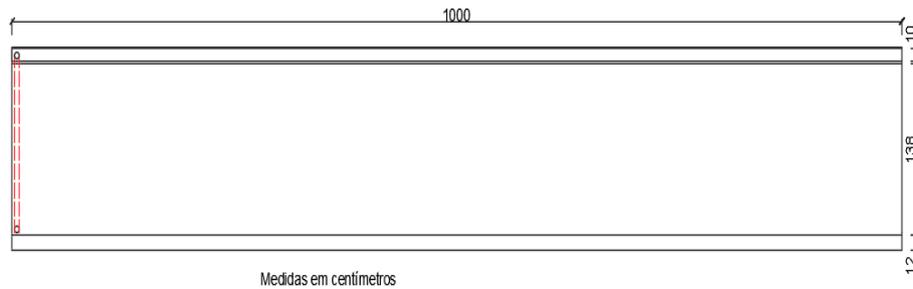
Planta da marquise com extensão da calha e do condutor horizontal
